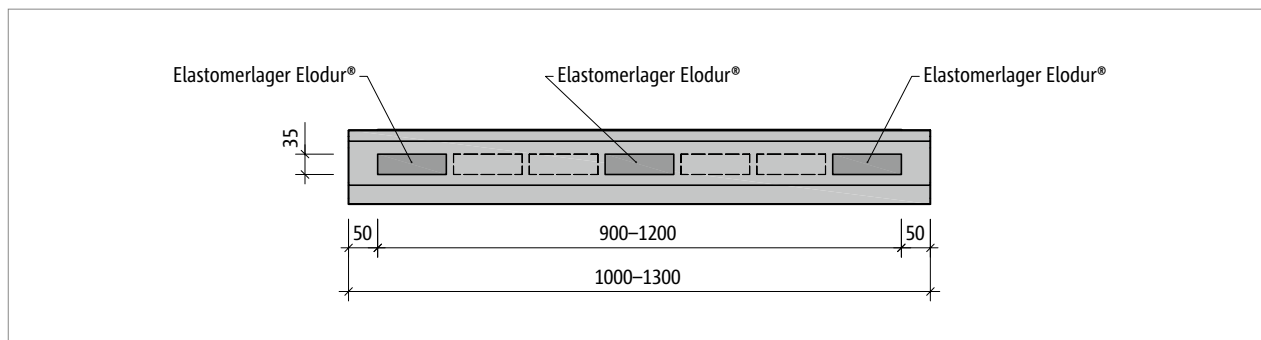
Schöck Tronsole® BL, BZ: Grundriss, beispielhafte Darstellung Tragstufe V1, Länge 1000-1300 mm
